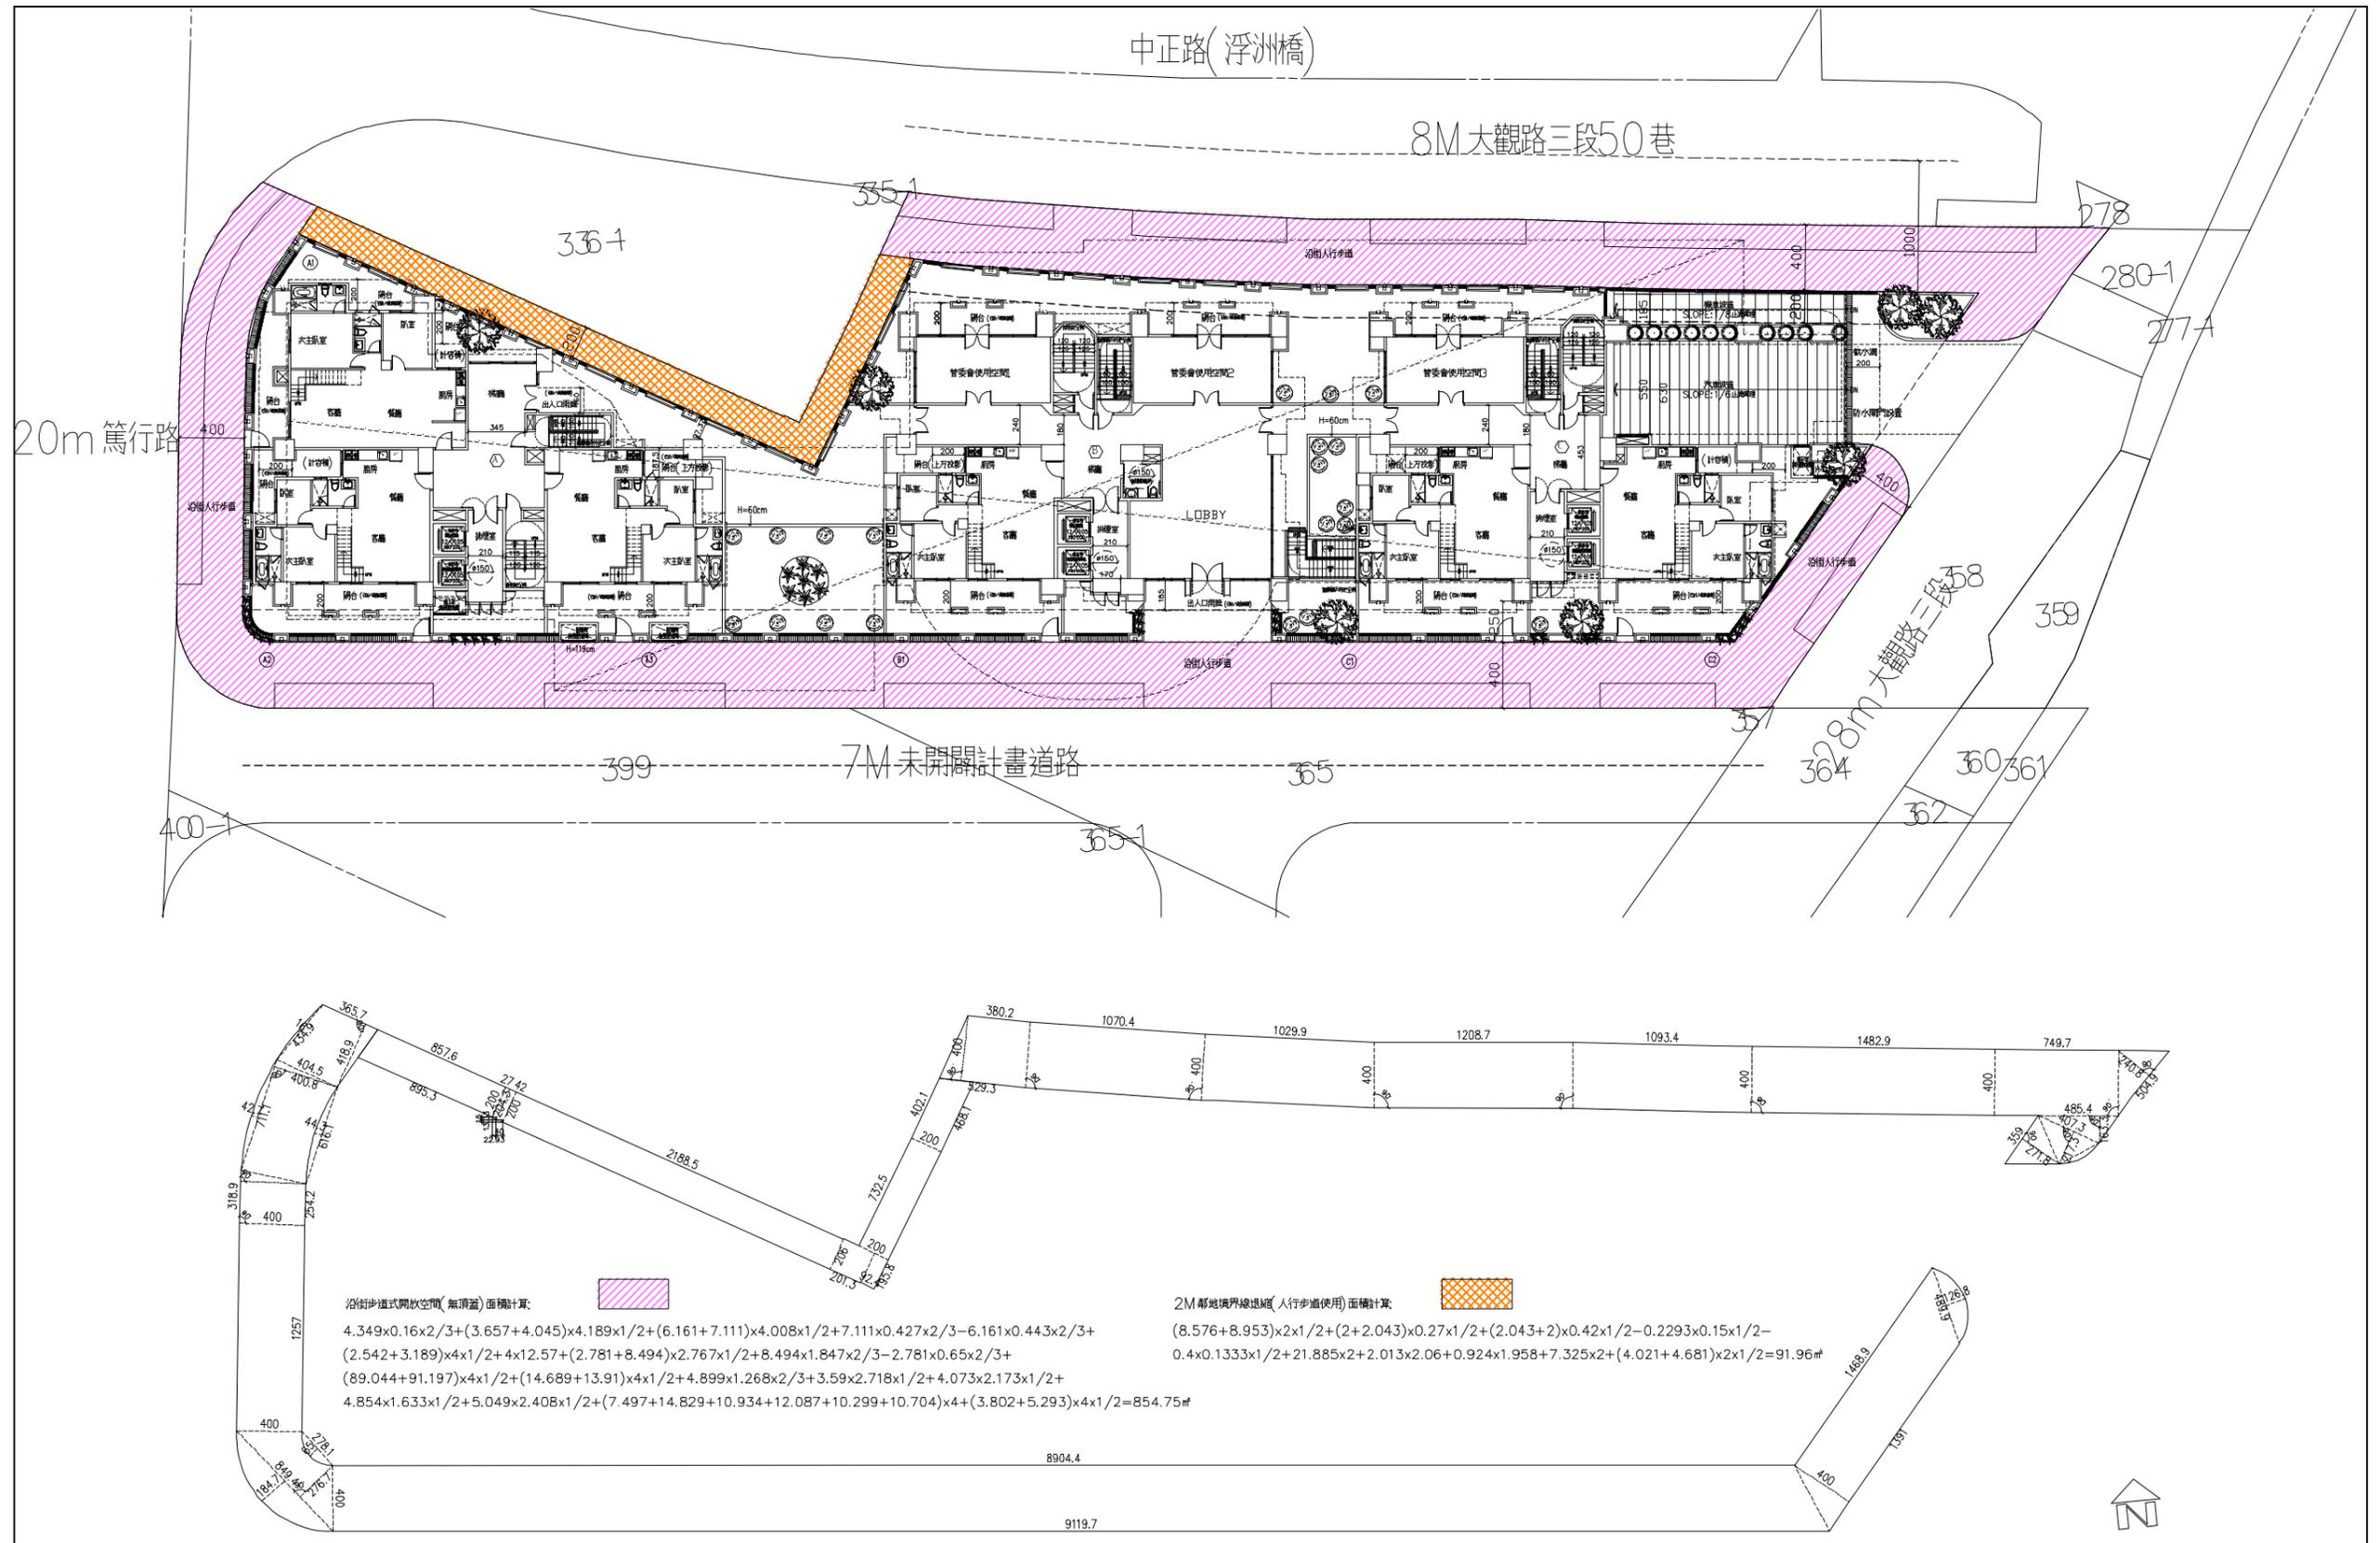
開放空間套繪一層平面示意圖(S : 1/400)
